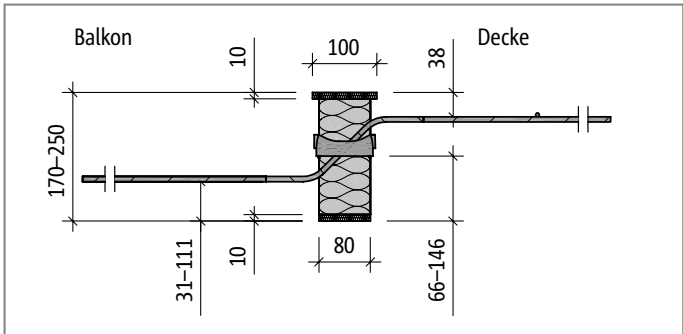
Schöck Isokorb® T Typ Q-ID-V4
